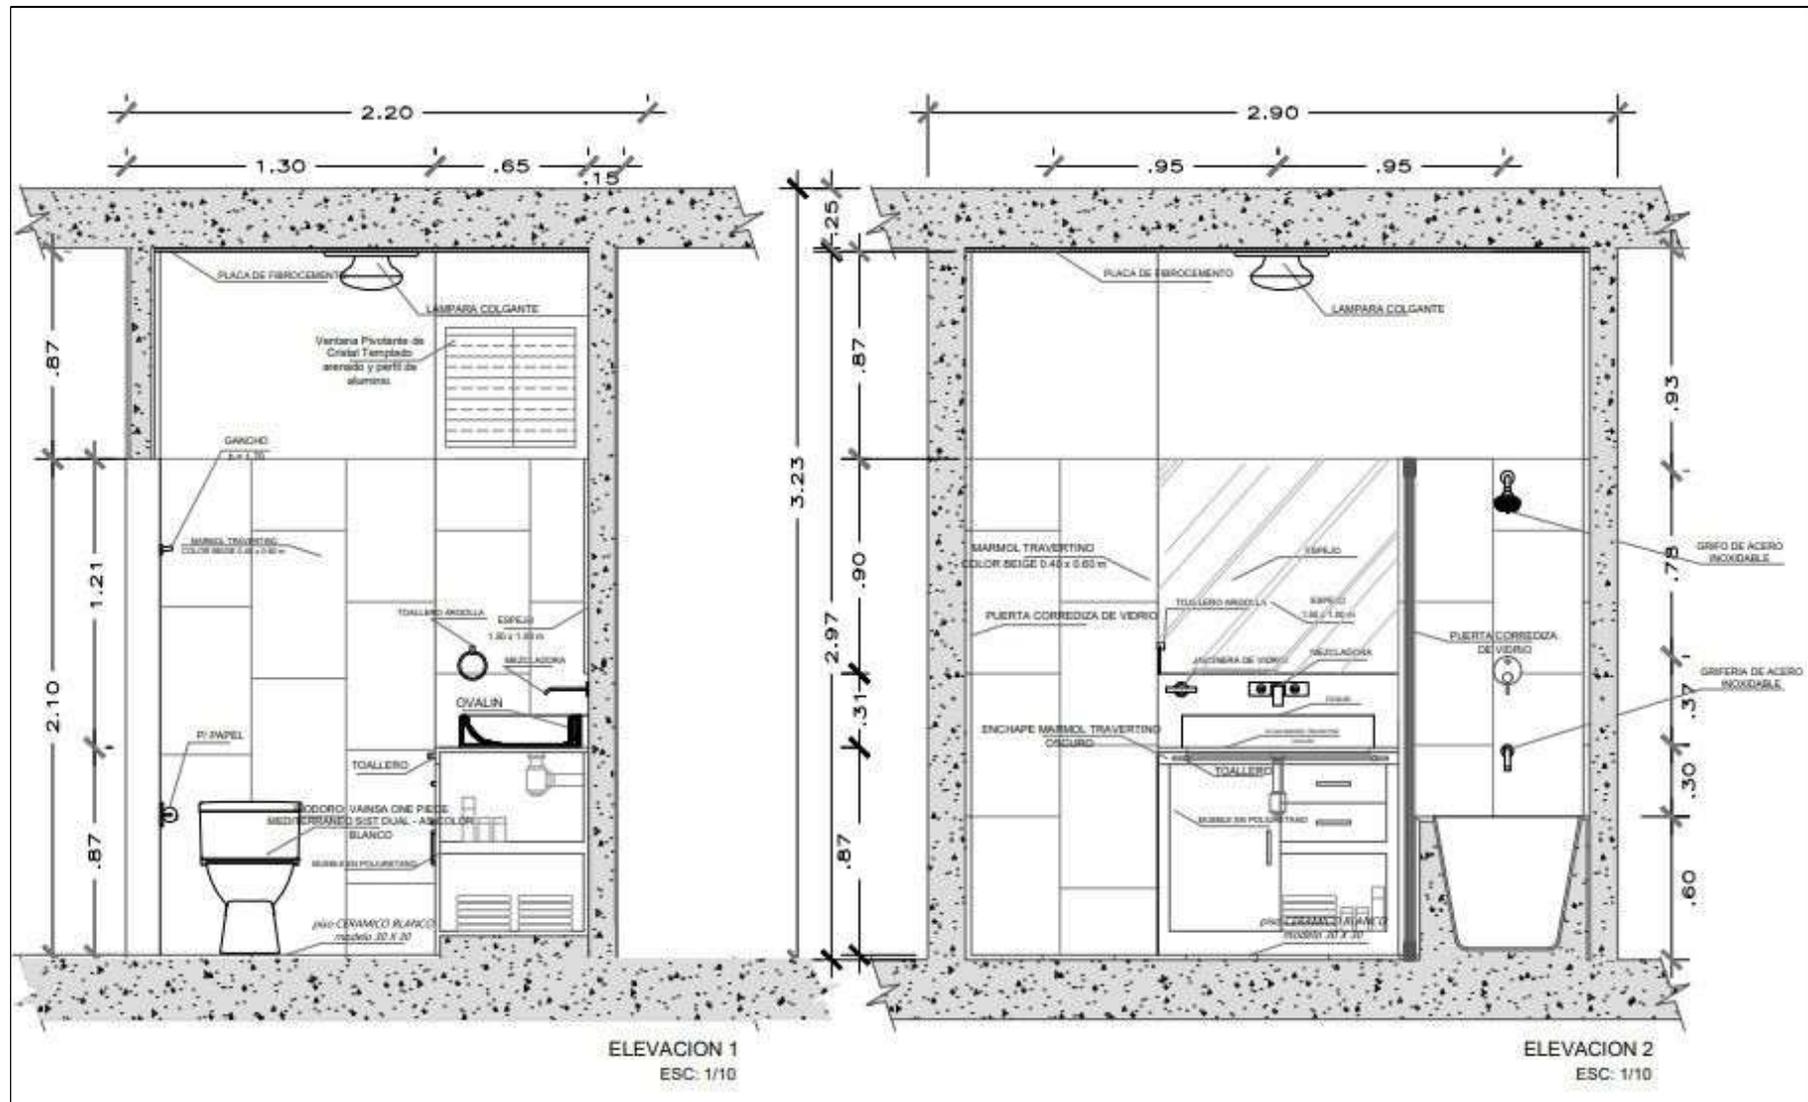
y 64: Elevación General– Sector Vivienda (lado sur y oeste), Fuente: elaboración propia.
